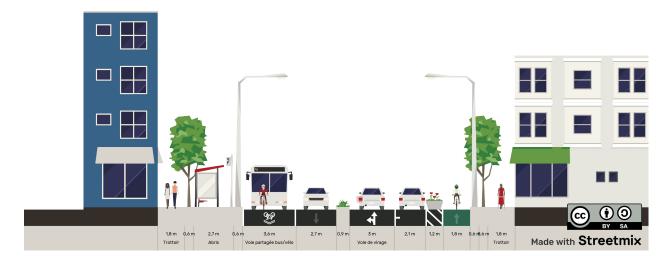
Exemple de profil d'une traversée. Source : Streetmix
